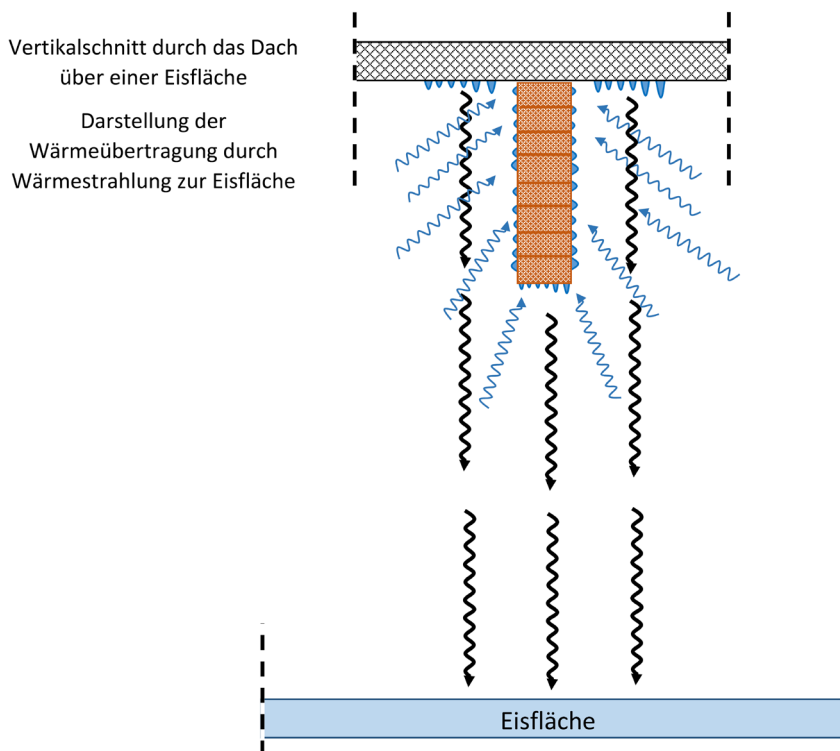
Prinzip der Wärmestrahlung mit Tauwasserbildung an der Dachkonstruktion
